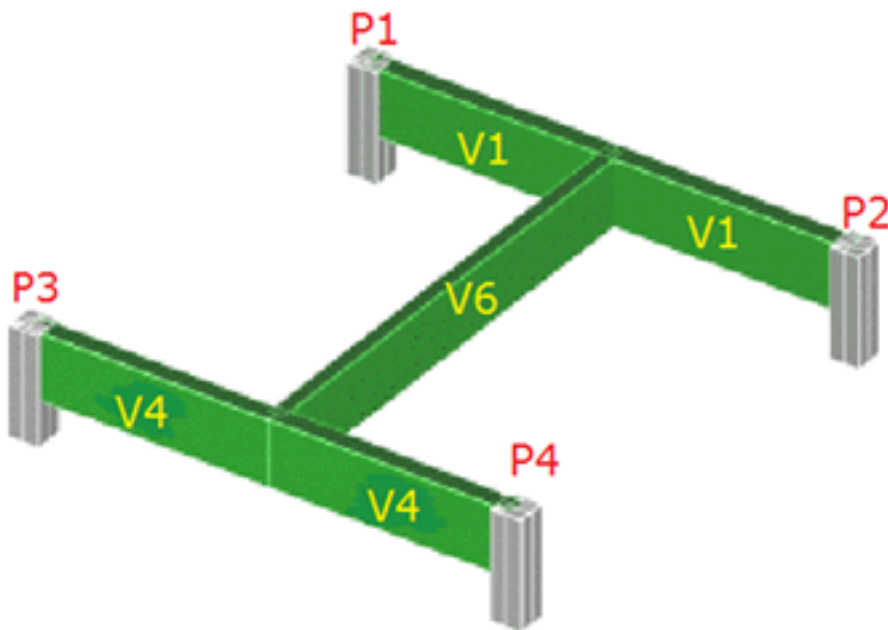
Lançamento da viga V6 no pavimento “ Tipo ”
